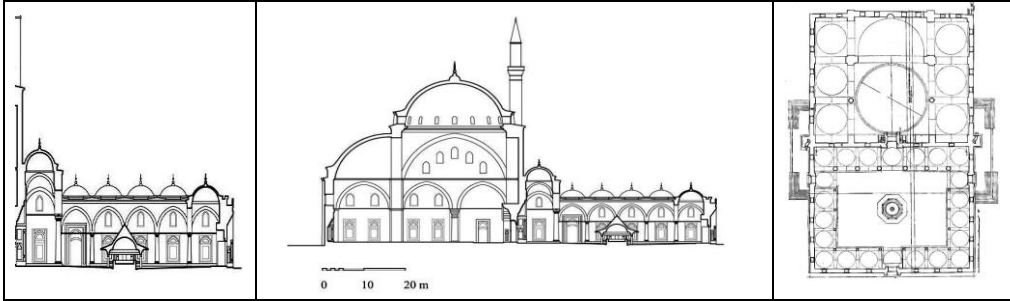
مسقط أفقي وقطاع لجامع مهرماه بأدرنة قاضي في إستانبول يوضح السقيفة المزدوجة التي تتقدمه.
